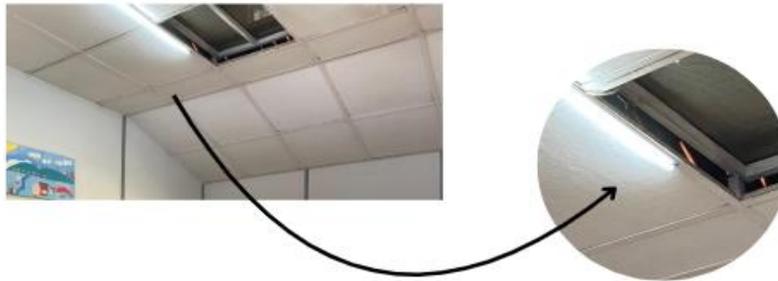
48 Material Plafond Pada Ruang Perpustakaan
